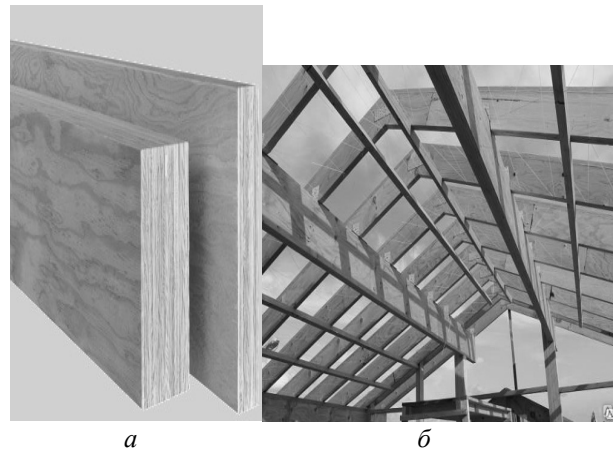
Фрагмент ЛВЛ-бруса (а) и строительного портала из него (б)
